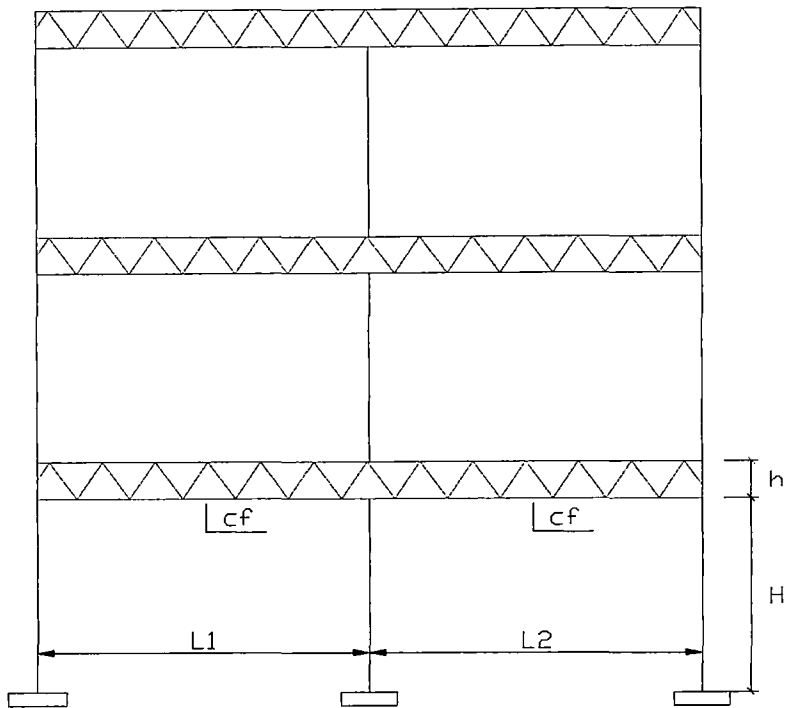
Vista en Elevación Típica de una Edificación que Emplea Tridilosa
